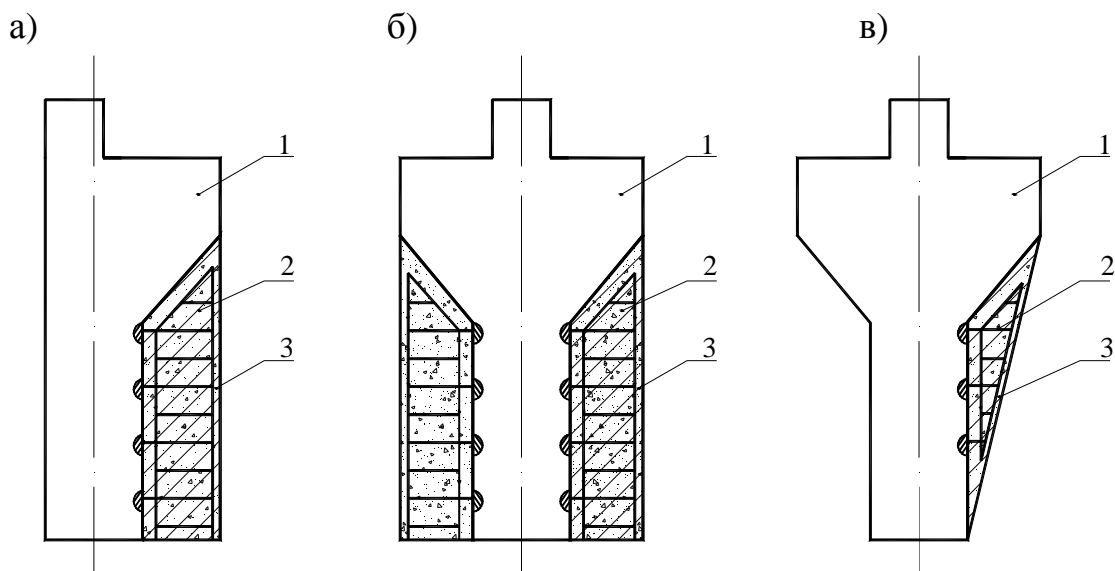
Конструктивні рішення підсилення консолей залізобетонних колон бетонуванням:
